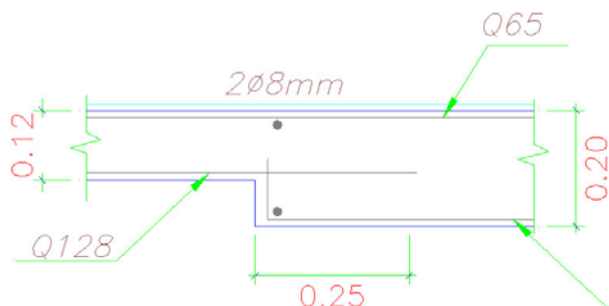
y Foto 2.3.59: Dimensiones de Ensanches de Losa en Zona de Baños.
